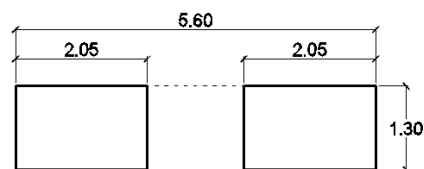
Alzado transversal de pila del puente sobre el río Tordera
